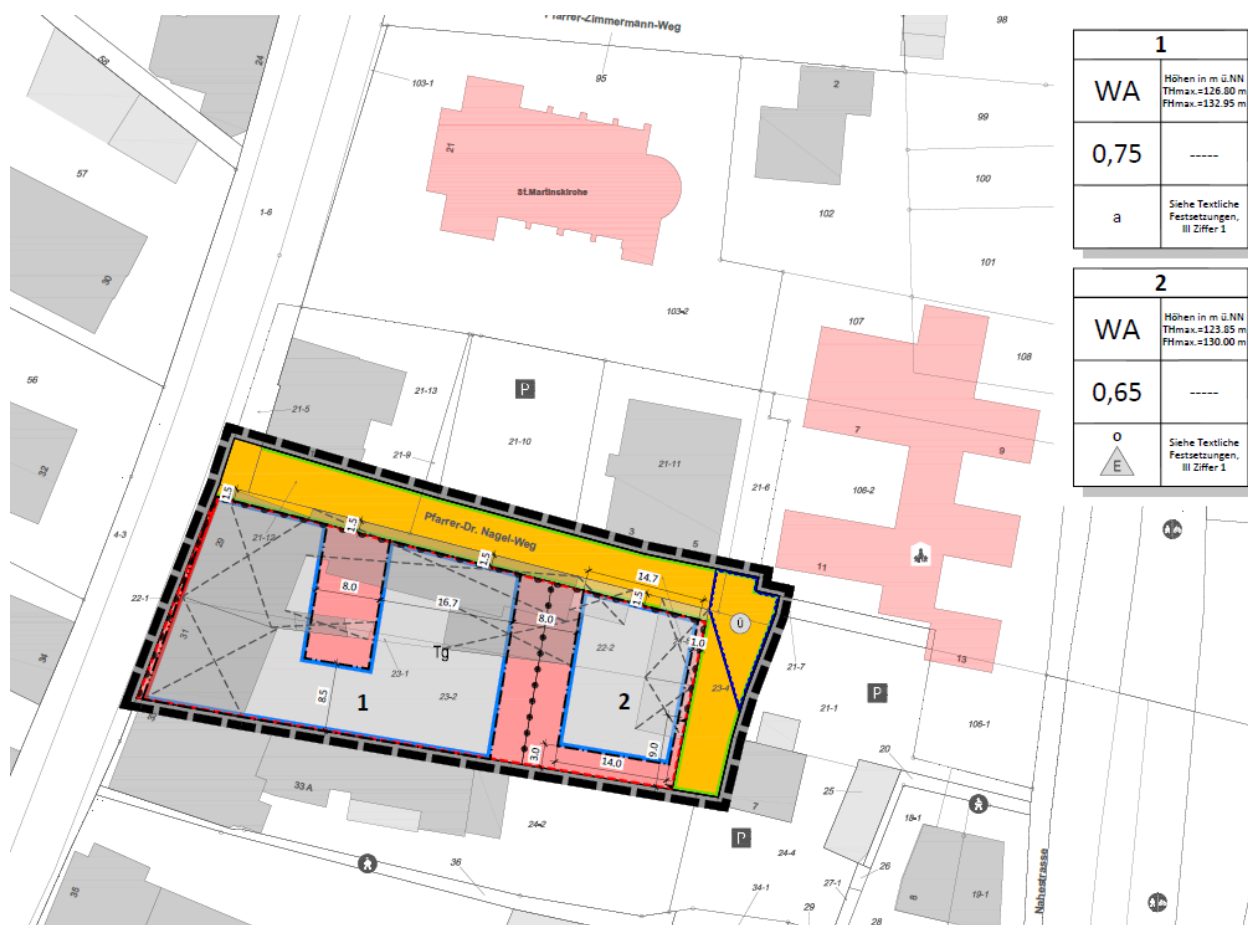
Entwurf Bauungsplan "Unterdorf, 2. Änderung"
